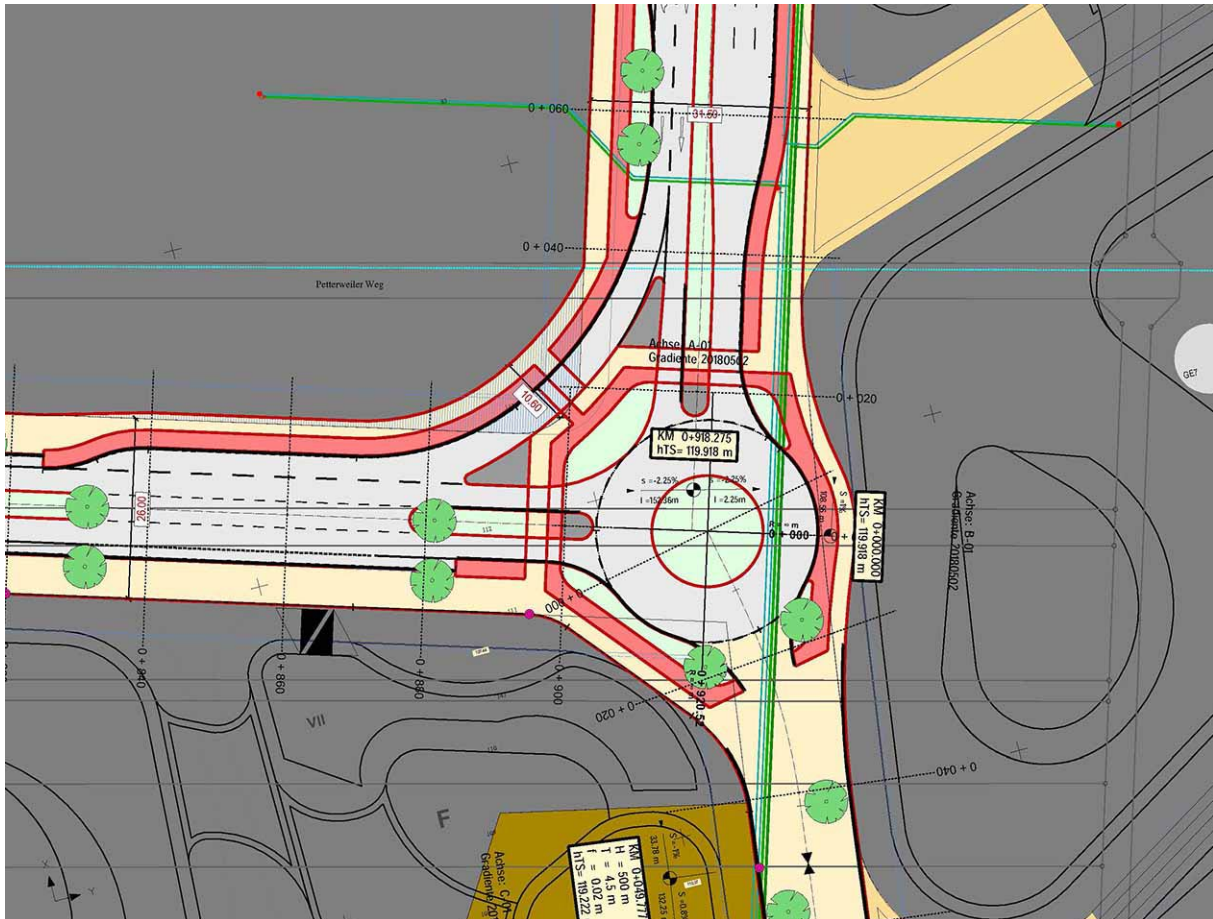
Draufsicht im Bereich des Kreisverkehrsplatzes und des Bypass der Gottlieb-Daimler-Allee (Quelle: IMB Plan, Hanau)
